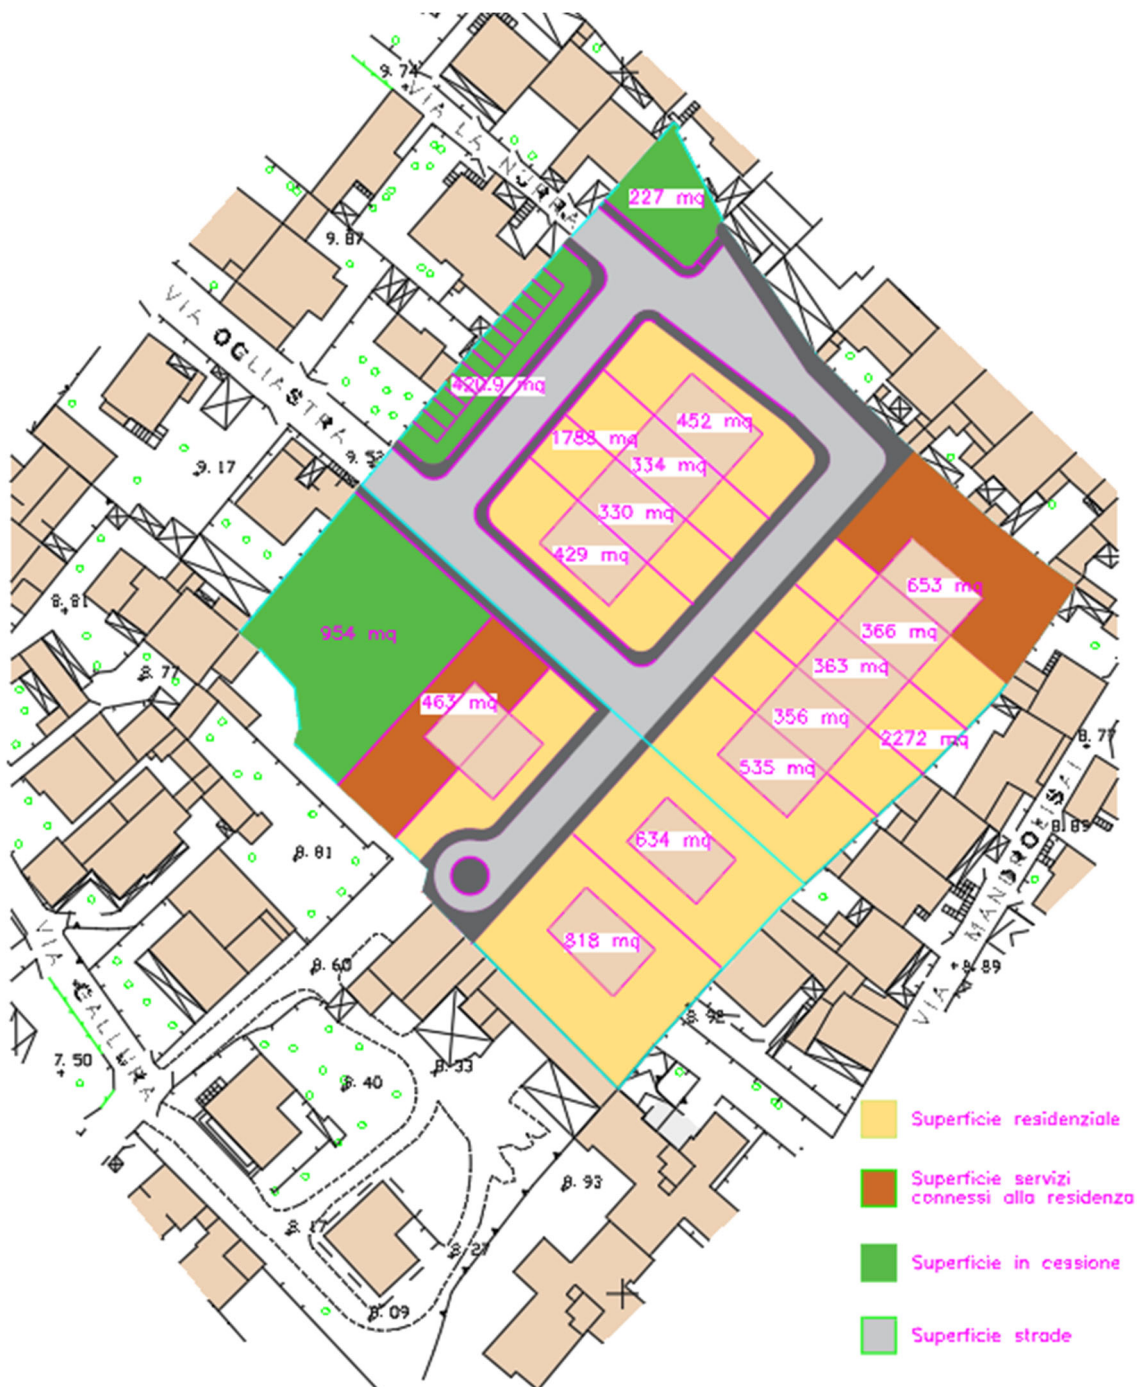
Planivolumetrico dell'area e sistemazione finale
